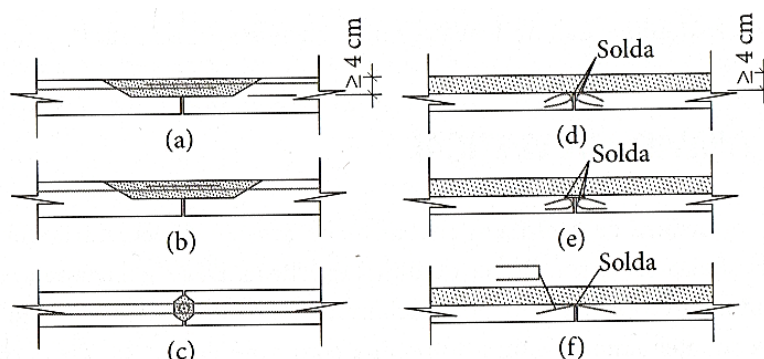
Detalhe da ligação entre painéis de lajes pré-moldadas. Fonte: Parsekian (2012).
